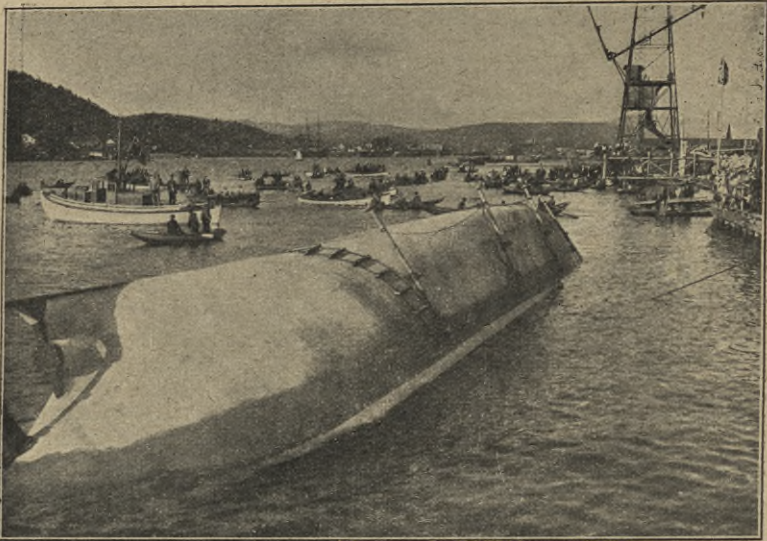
Eisenbetonschiff von 200 Tonnen, Bauweise Alfsen. Stapellauf.
